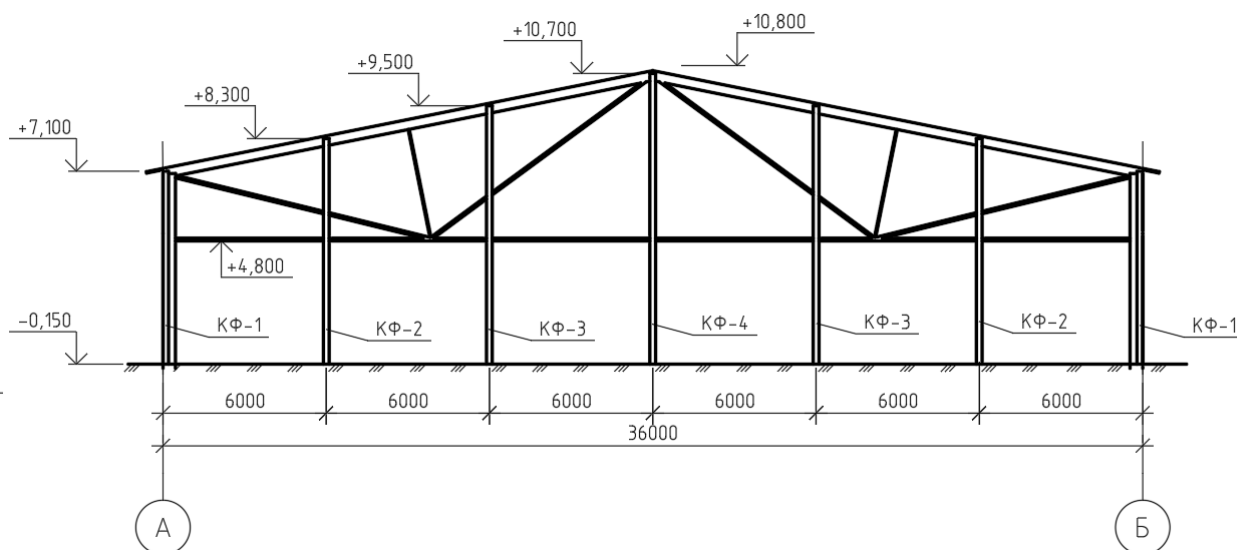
Схема расположения фахверковых стоек
